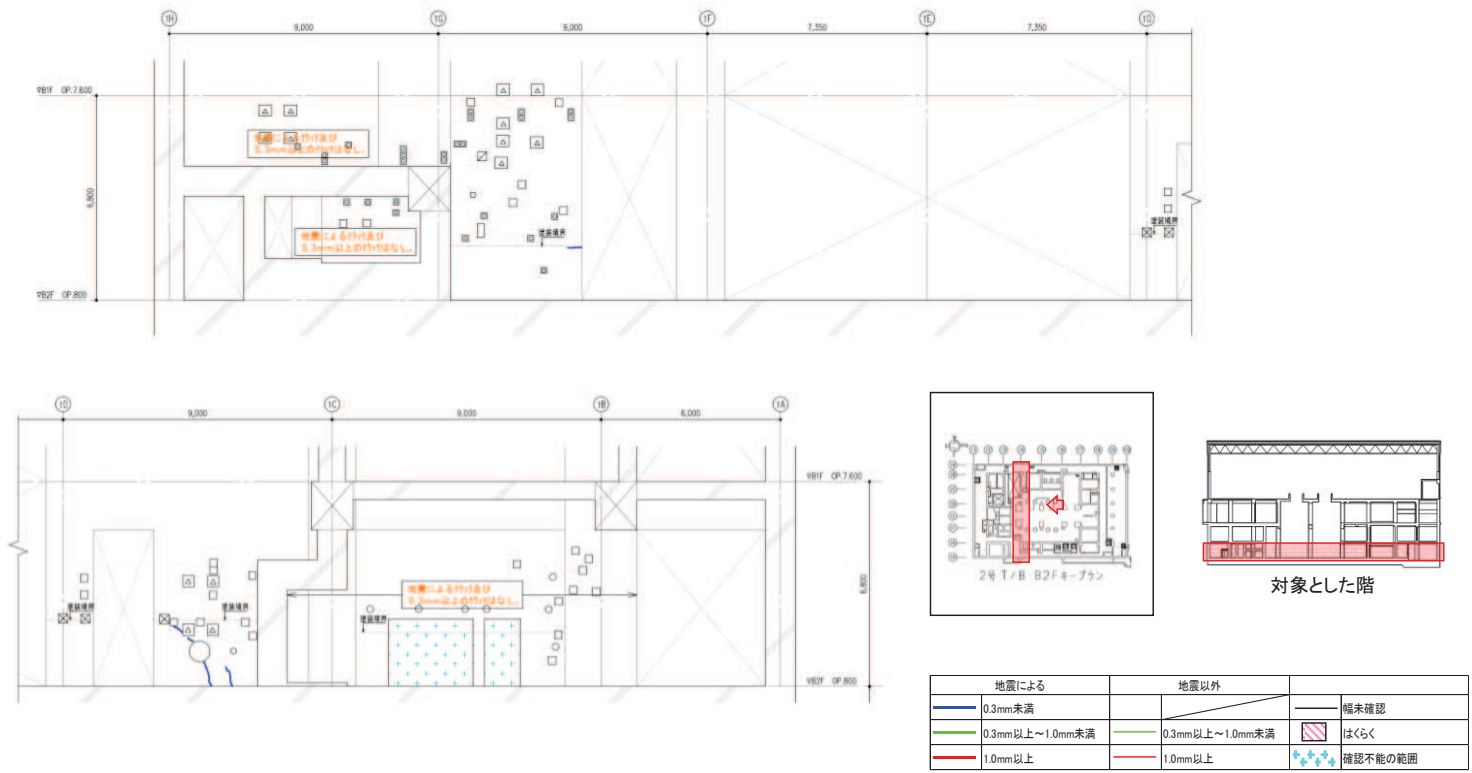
タービン建屋のひび割れ分布 耐震壁(4) 地下2階 T4 通り
